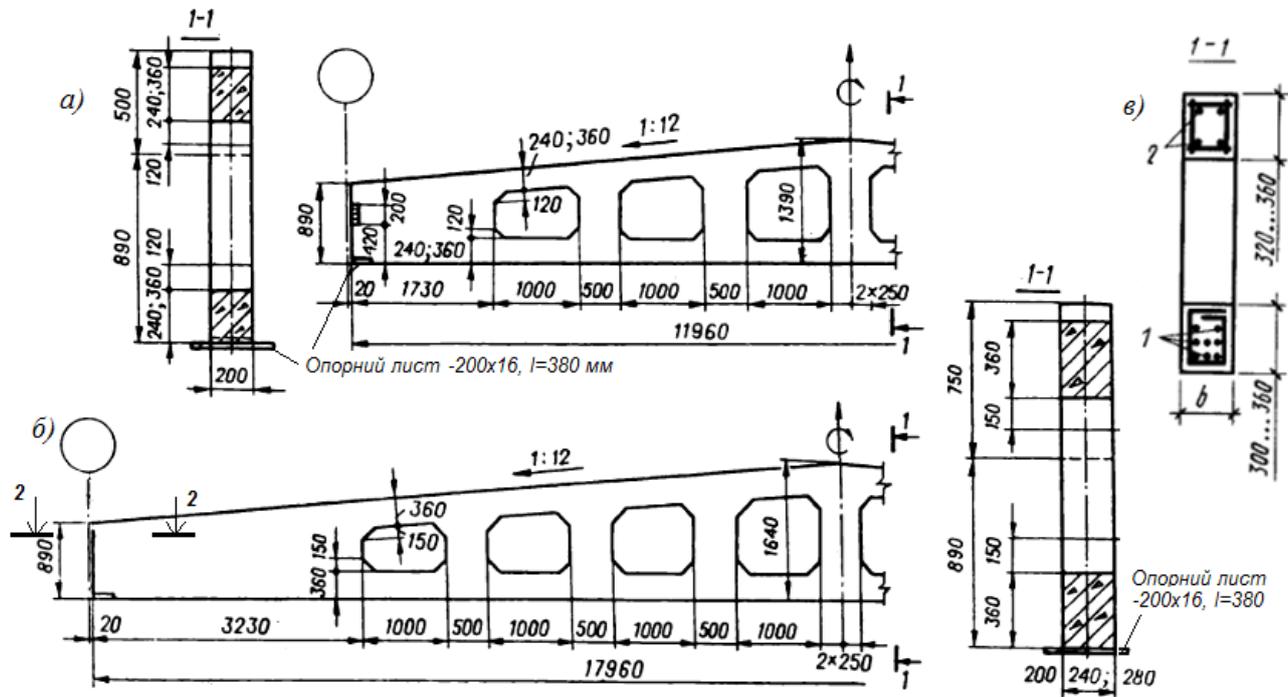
Гратчасті (перфоровані) залізобетонні балки покриття прольотами: а - 12 м; б - 18 м; в - схема армування; 1 - попередньо напружена арматура; 2 - арматурний каркас
